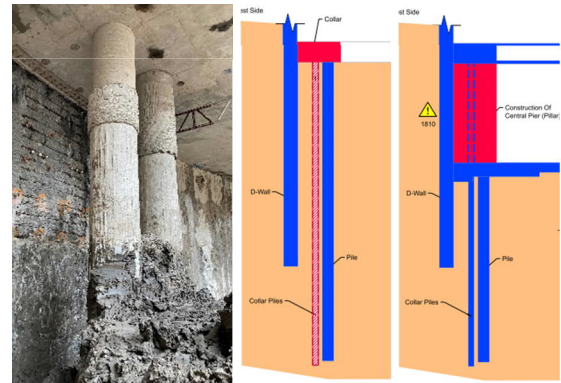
Izquierda imagen de los pilotes ejecutados. Centro etapa de ejecución de los pilotes. Etapa de ejecución del pilar central.
